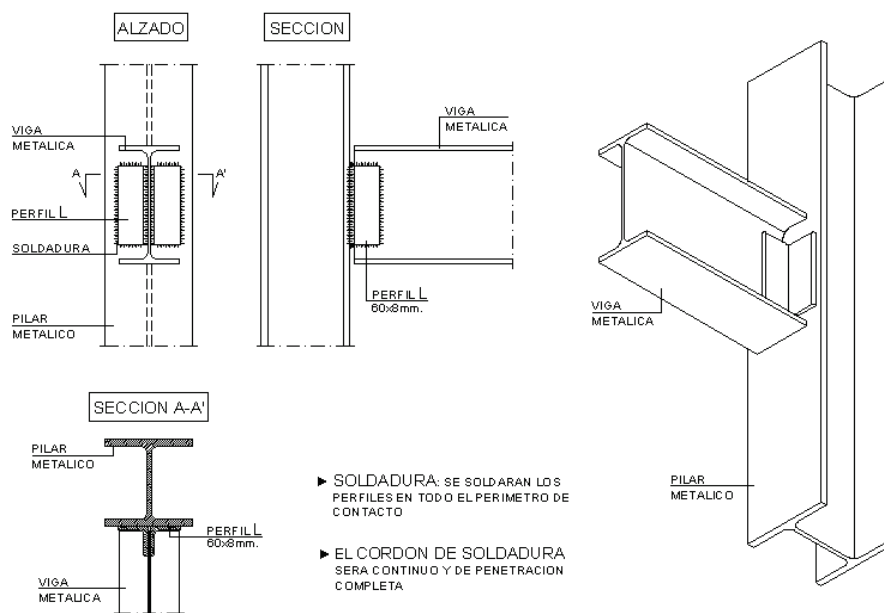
Conexión soldada con ángulos soldados al alma¹⁶
